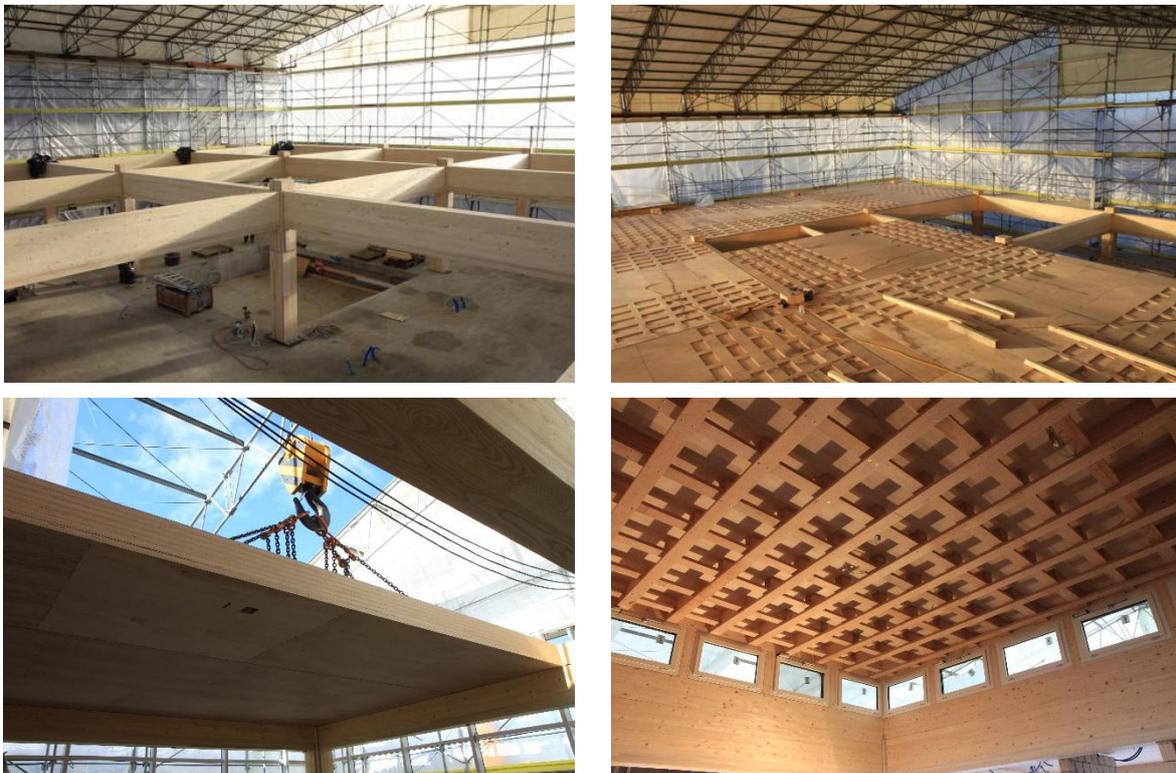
ETH House of Natural Resources im Bau: vorgespannter Holzrahmen (oben links); Buchenplatten als Schalung und Bewehrung für die Holz-Beton-Verbunddecke (oben rechts); Montage der vorgefertigten Dach-Hohlkastenelemente (unten links); Flächentragwerk aus Buchenholz im zentralen Feld des Daches (unten rechts)
